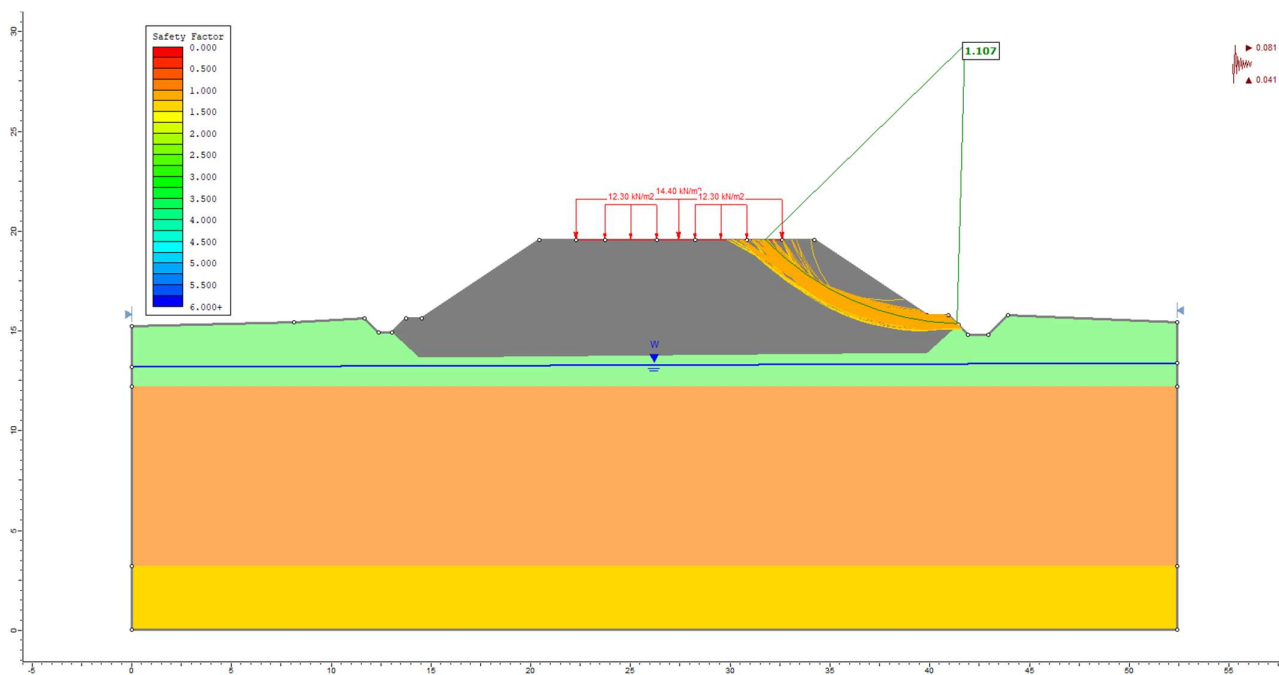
Rilevato sezione n° 12 alla pk 26+800 - Analisi SLU in campo sismico
